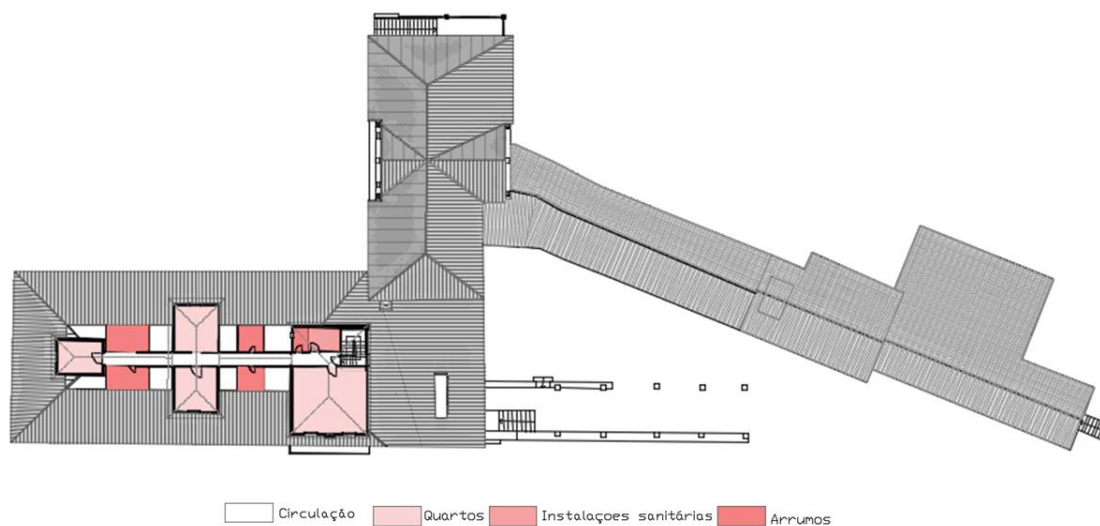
Planta do sótão da Casa de Santo António de Vessadas
